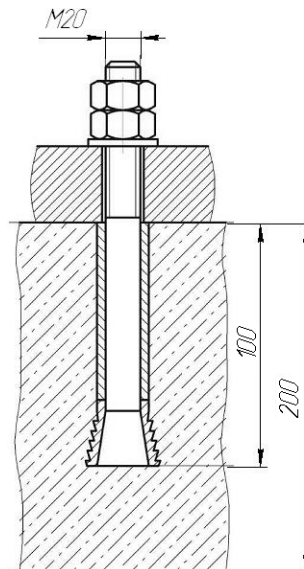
Эскиз фундаментного болта для крепления корпуса маслопресса
